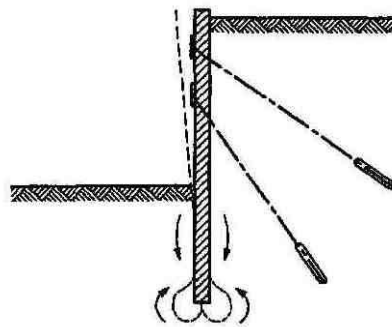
Приклад граничної форми вертикального руйнування закладених стін
